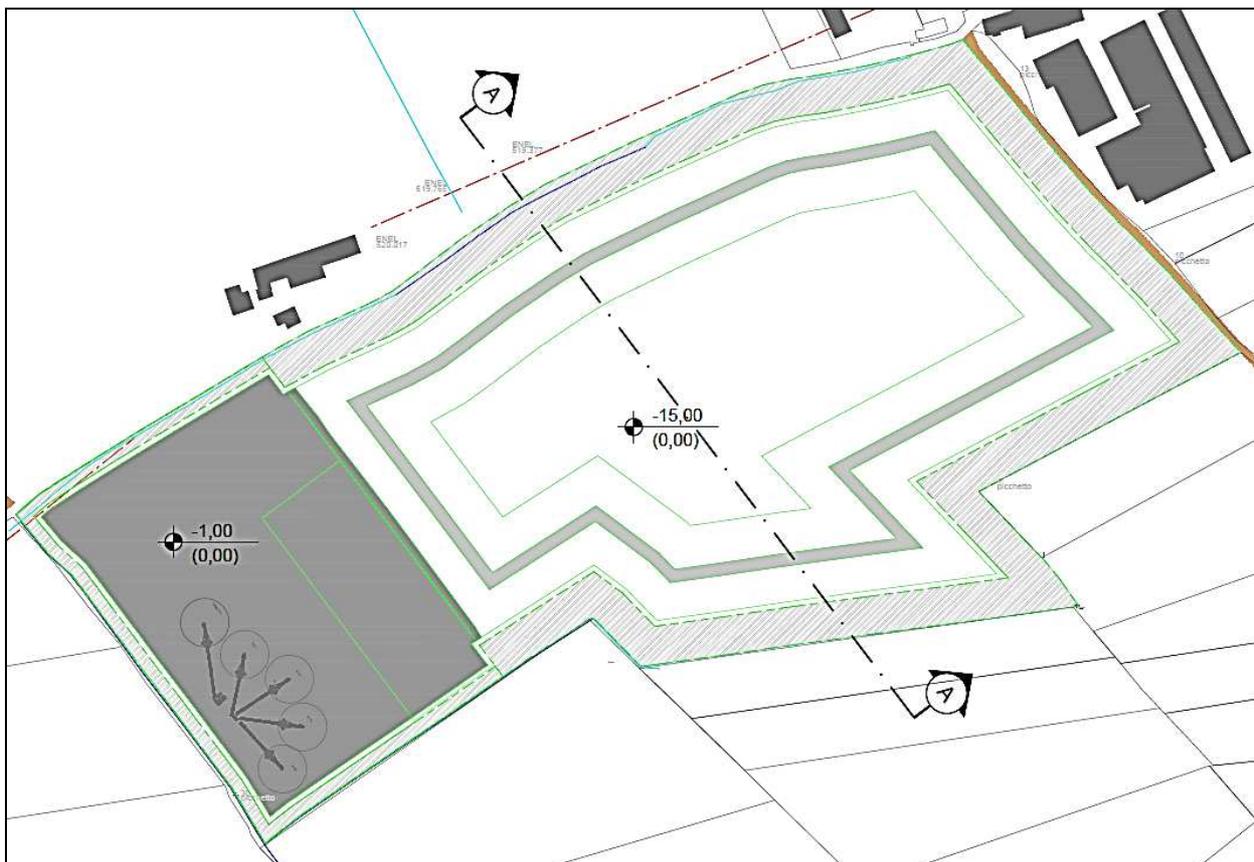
bis – Estratto tavola 02 - “Fasi di scavo lotto 1”; situazione di massimo scavo ipoteticamente raggiungibile
